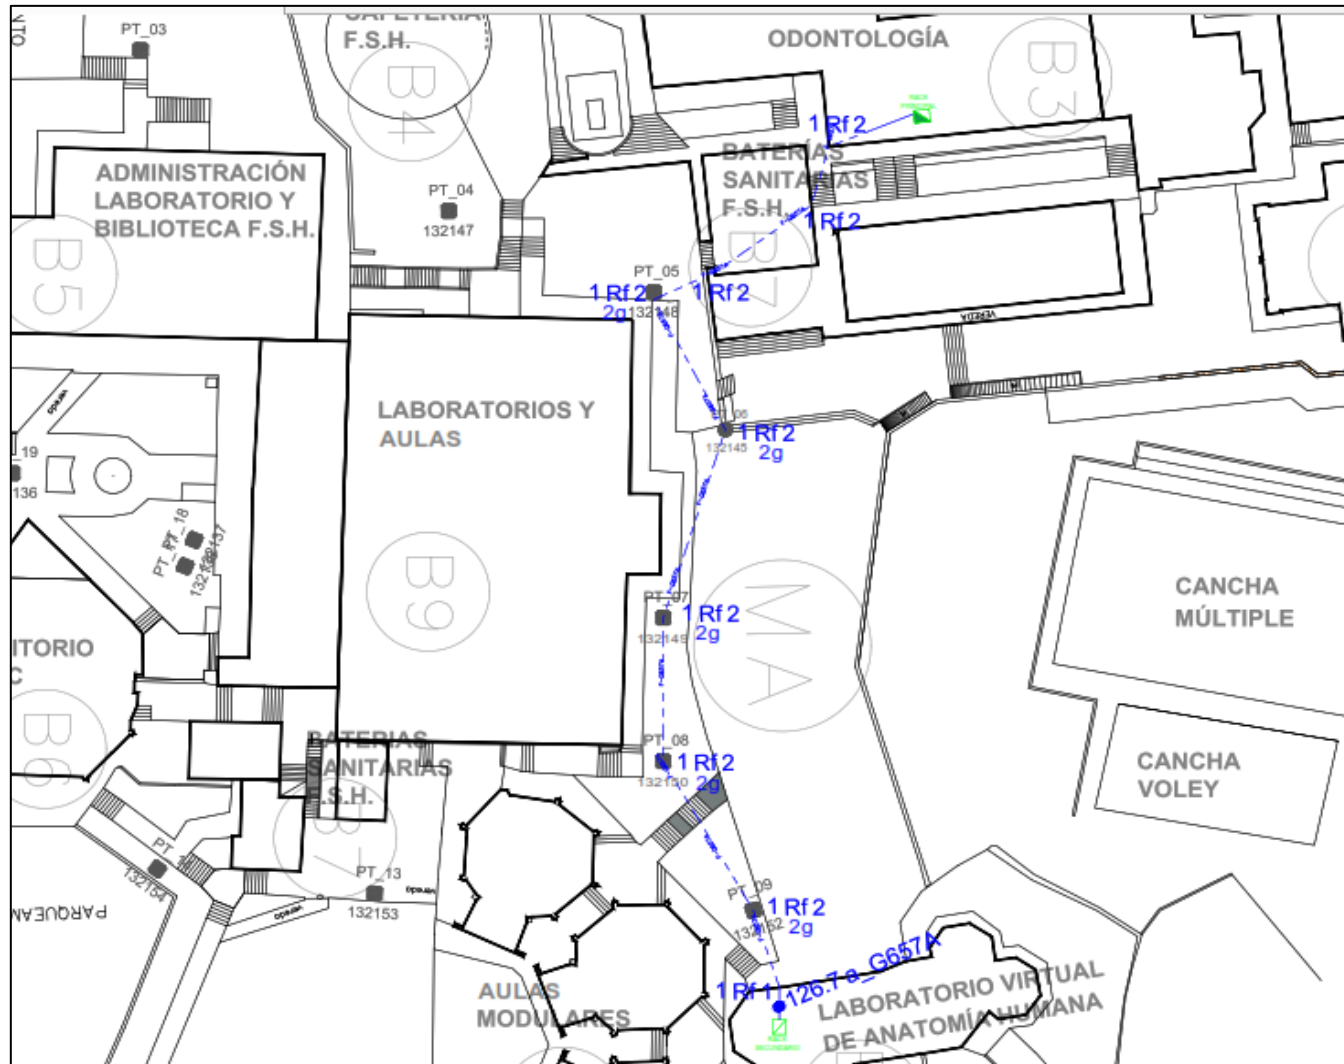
Planimetría del tendido aéreo para el enlace de fibra óptica del bloque 10.
